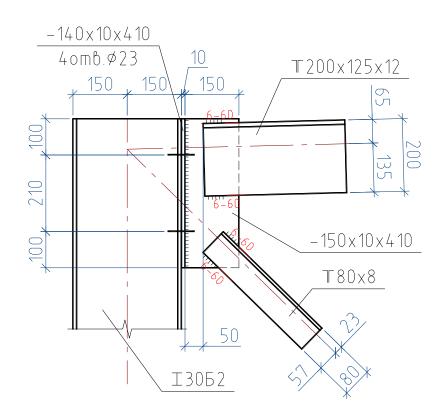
Узел примыкания верхнего пояса с надколонником
